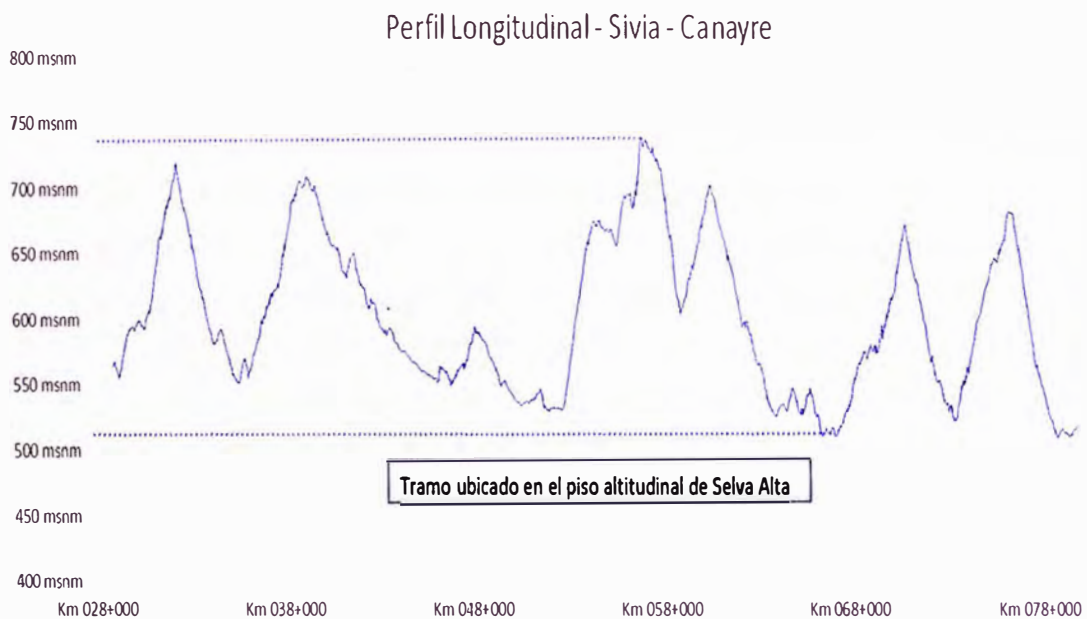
Perfil Longitudinal Sivia – Canayre
